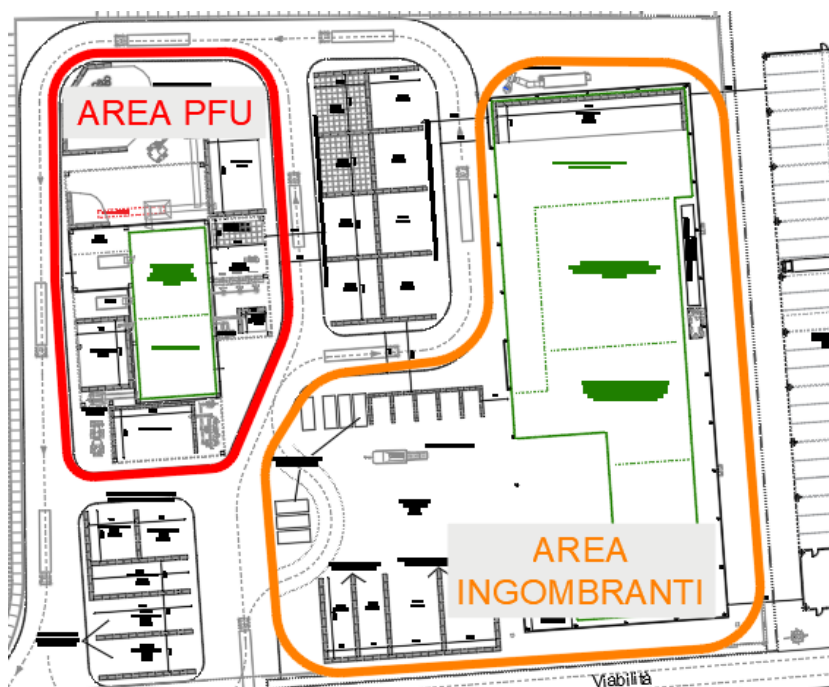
Planimetria di progetto complessiva dei futuri impianti di trattamento PFU ed Ingombranti e suddivisione delle aree di pertinenza delle rispettive attività presso la nuova area impianti PNRR.
